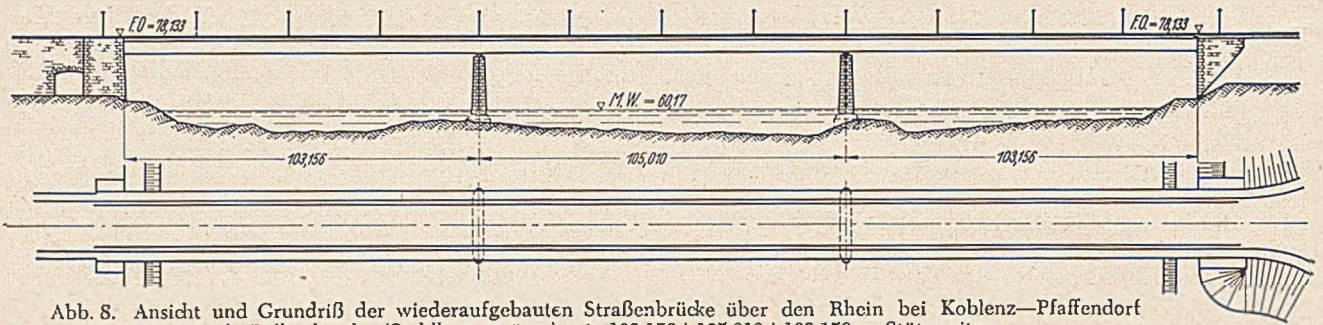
Ansicht und Grundriß der wiederaufgebauten Straßenbrücke über den Rhein bei Koblenz—Pffaffendorf als Balkenbrücke (Stahlkastenträger) mit 103,156+105,010+103,156 m Stützweiten.
